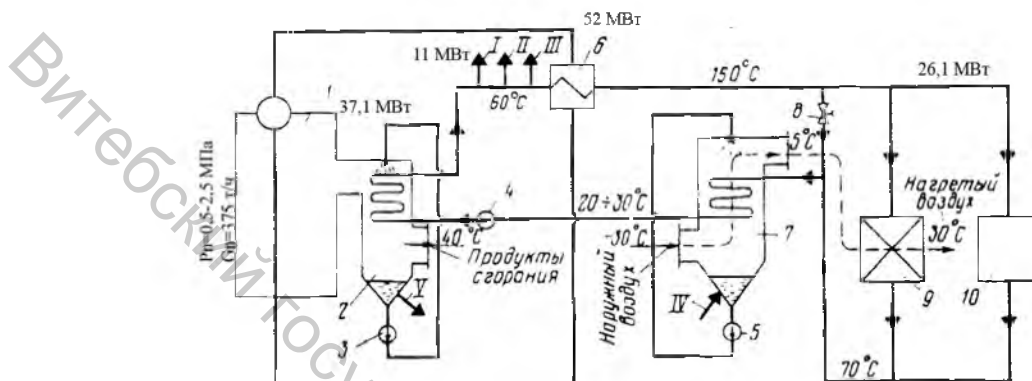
Схема теплоснабжения с контактными теплообменниками в газоходе котла и воздуховоде приточной отопительно-вентиляционной установки потребителей теплоты:
